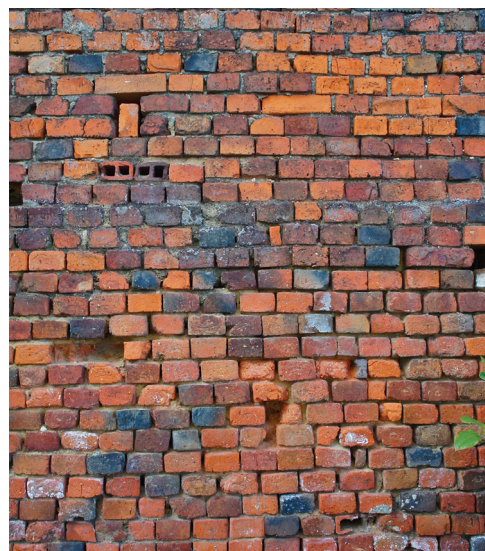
Muro de alvenaria estrutural de tijolo cerâmico de face à vista. Cerâmica Progresso da Pampilhosa
